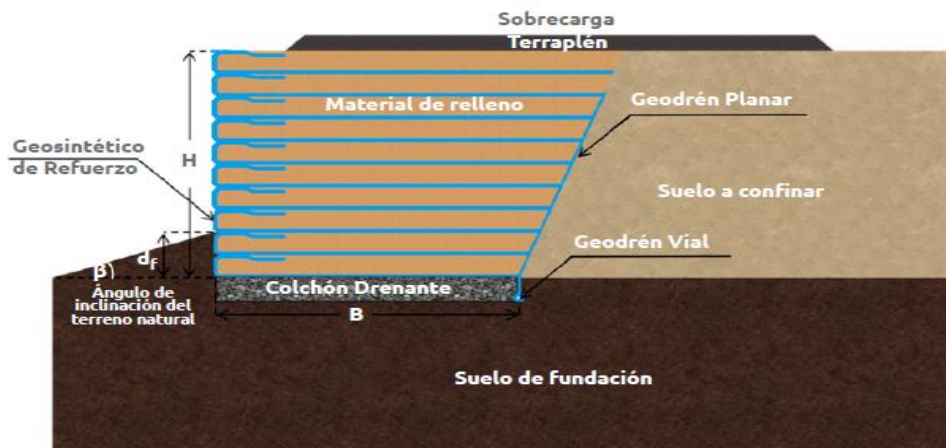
Esquema General Muro en Suelo Reforzado (Diseño de Infraestructura con geosintéticos, 2021, p.378)
